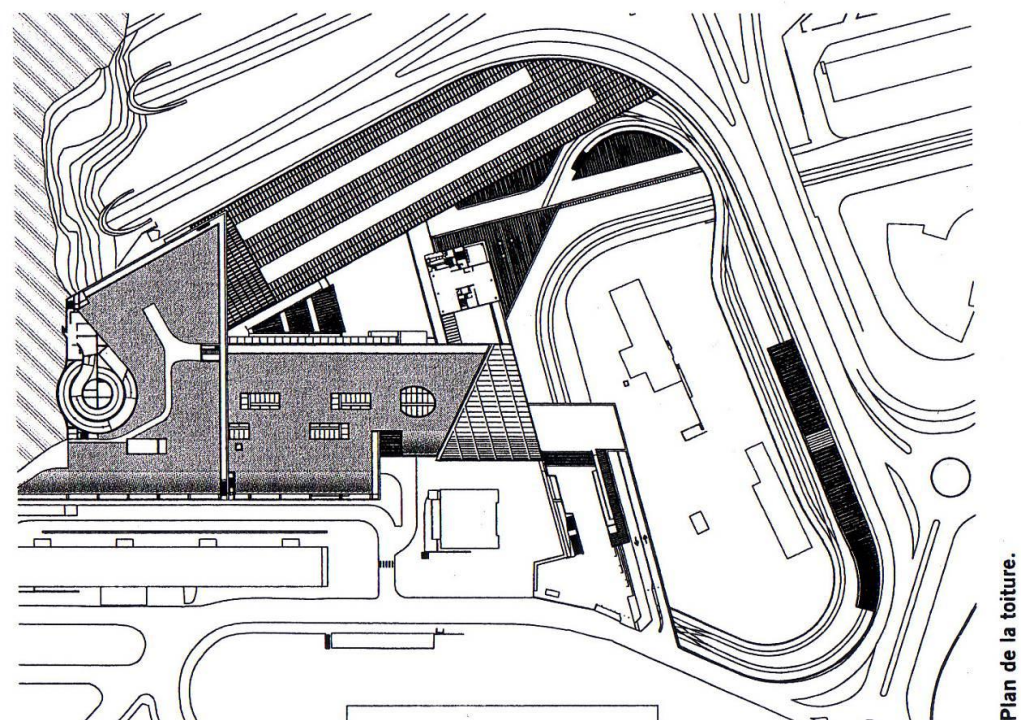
Pôle multimodal de Las Planas : plan des toitures Atelier Barani
